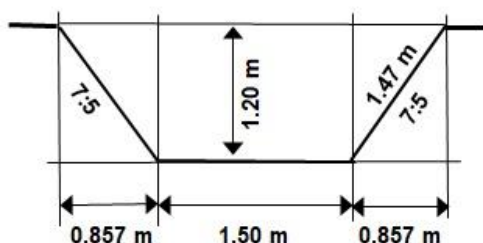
; Ausschnitt aus Plan Haltungen Generellen Entwässerungsplanung (GEP) Berechnung (ohne Masstab)
